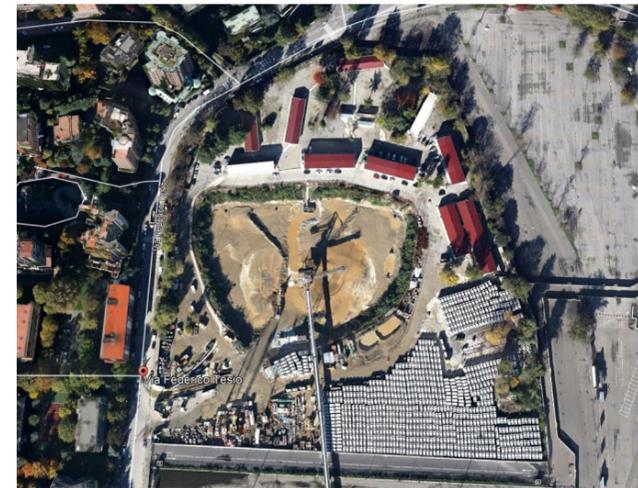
Ortofoto del 2011 - Cantiere di realizzazione della linea M5
